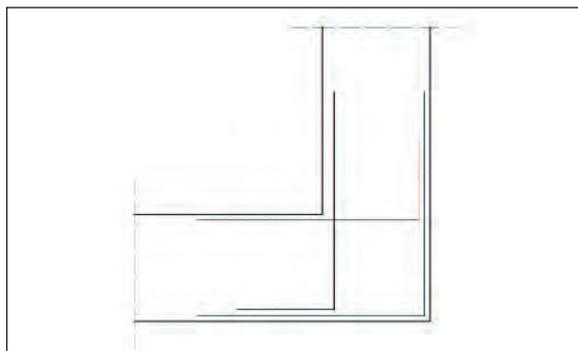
Eckbewehrung (Horizontalschnitt)
